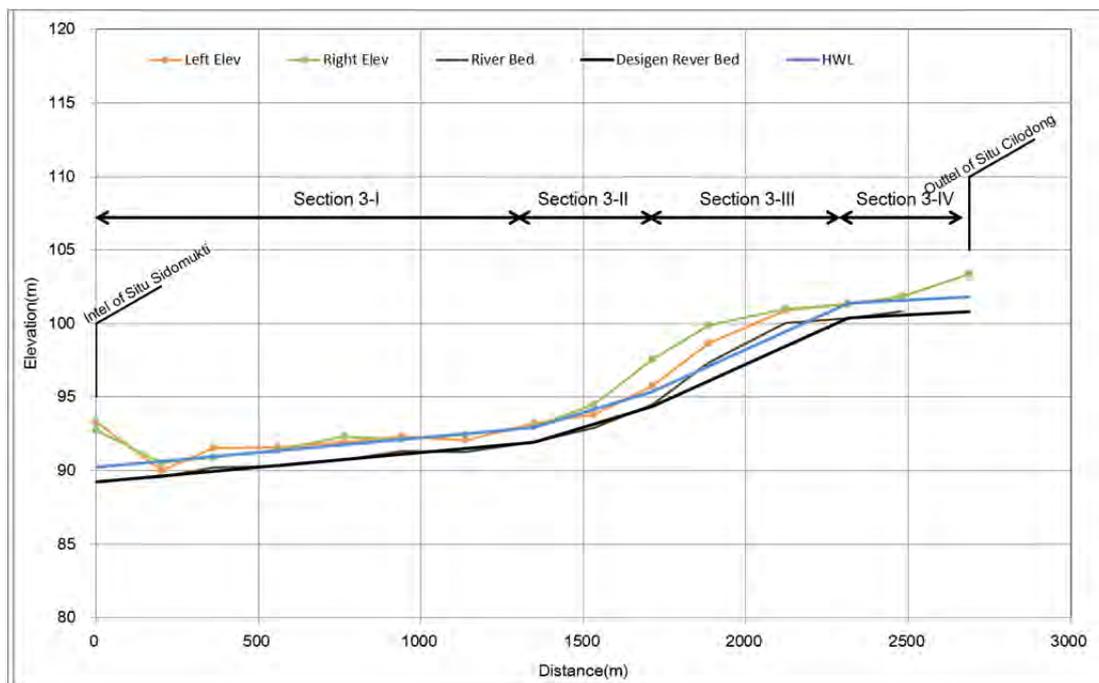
Situ Sidomukti ~ Situ Cilodong 計画縦断面図
